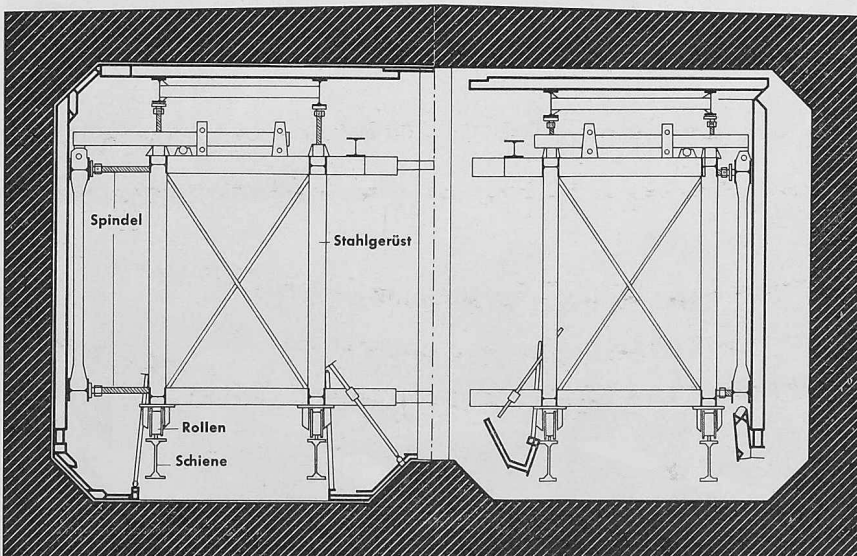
Verfahrbare Stahlschalung für Herstellung des Tunnels in wasserdichtem Beton. Masstab 1:75
